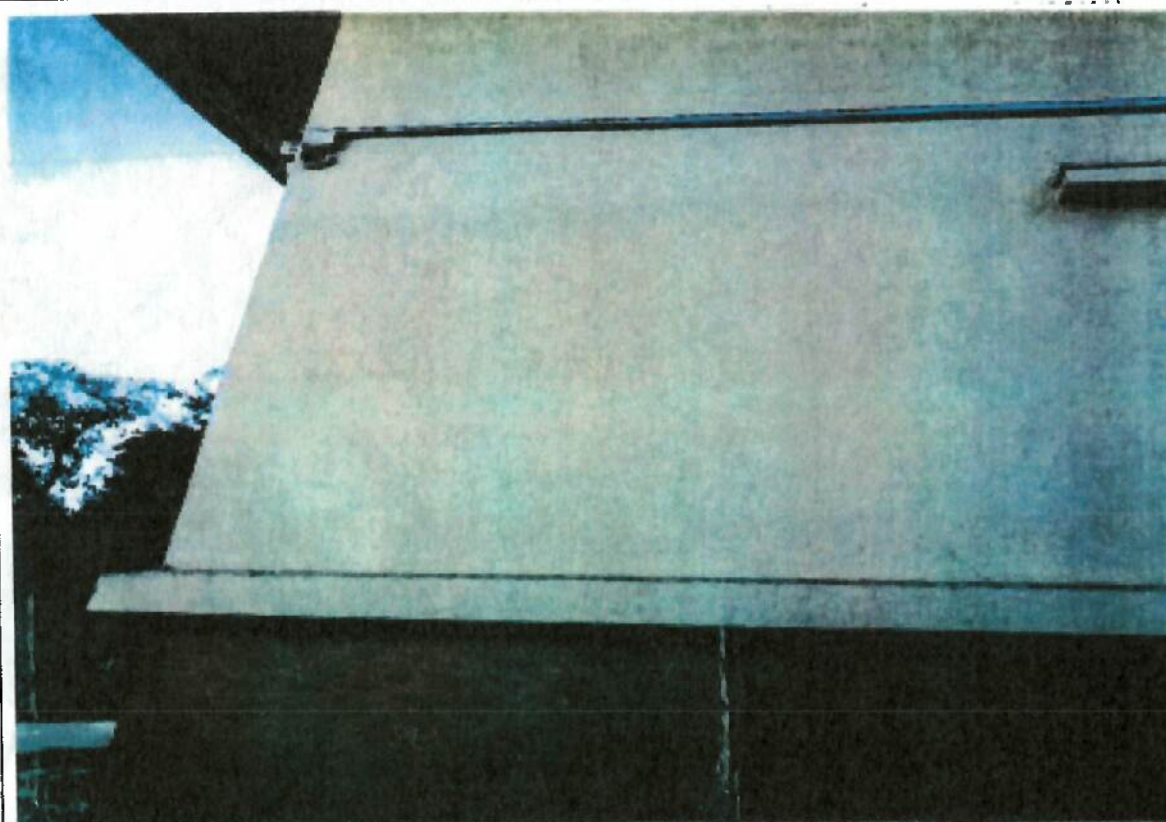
Situație existentă – Fisuri verticale și înclinată în parapet zona curba, parter, Corp C1-Tronson A
